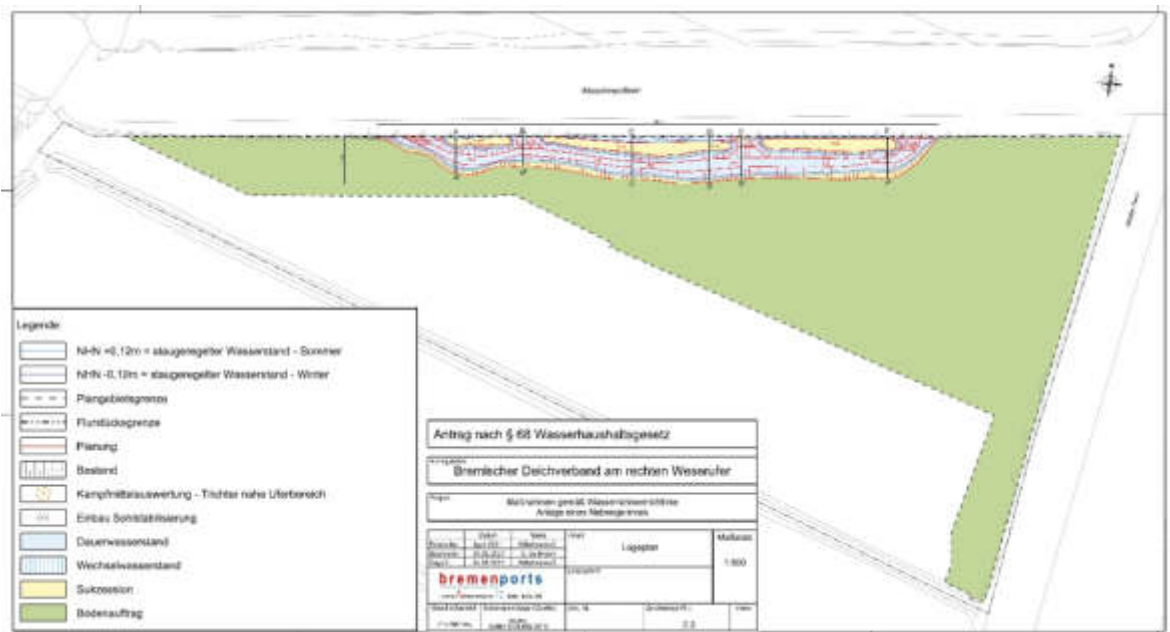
Planung Maschinenfleet oh Waller Straße (Abbildung aus wasserrechtlichem Antrag, leicht verändert).
